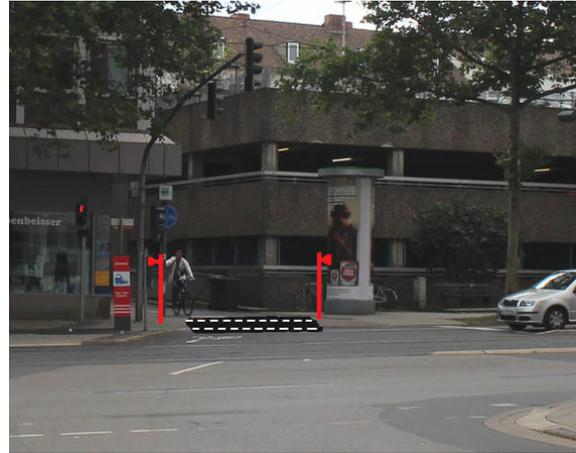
(Bild 3): Mit dem Parkhausneubau ist hier eine separate Fußgängerampel mit abgesenkter Furt im Gehwegbereich nötig.
